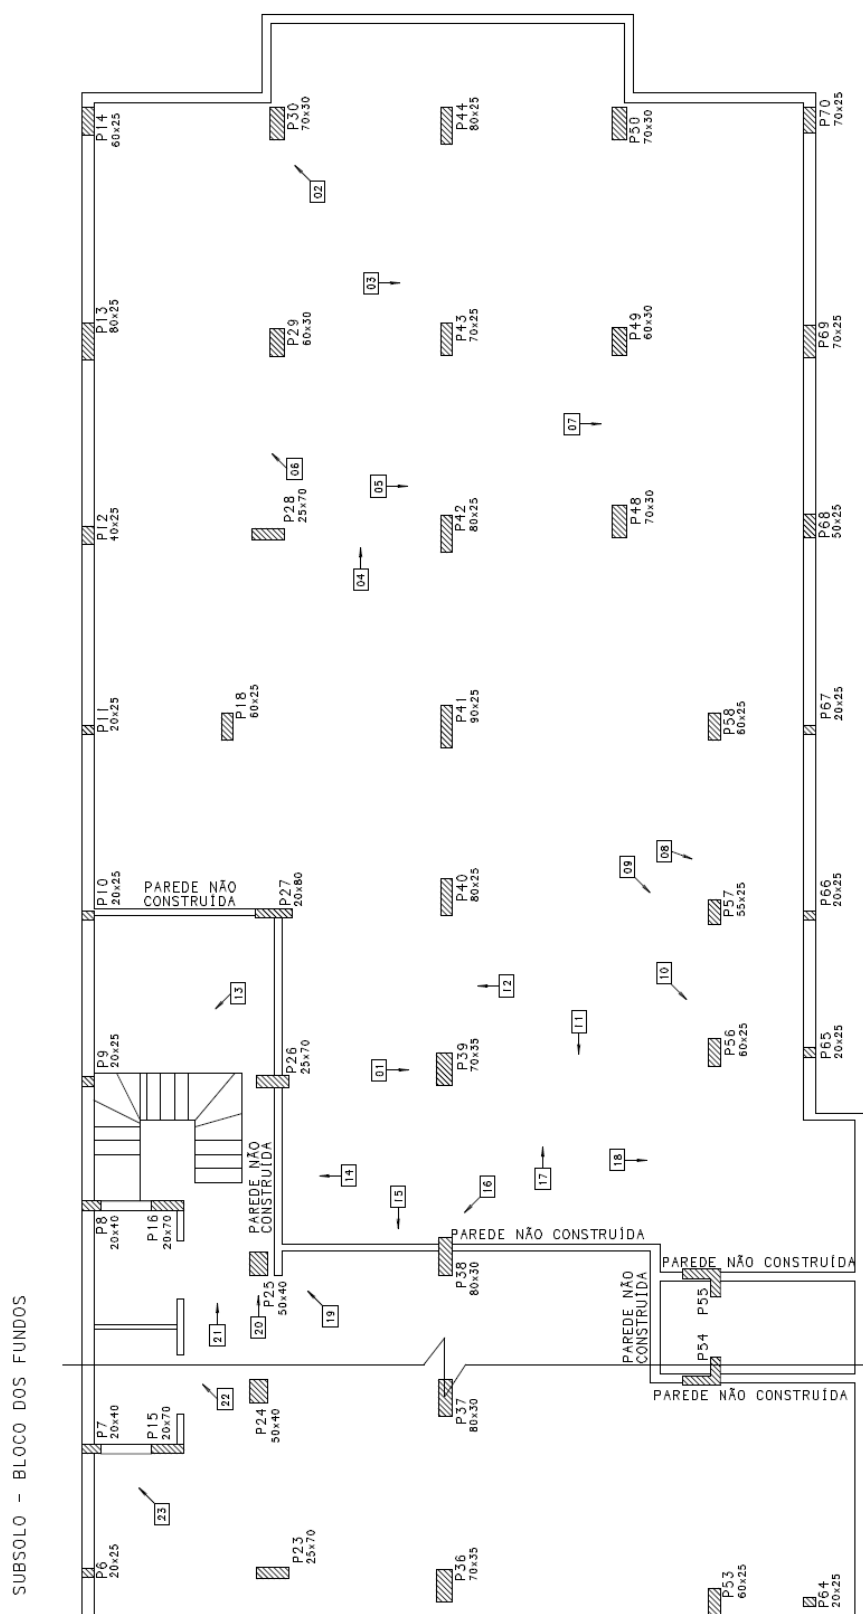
Planta baixa Bloco dos Fundos com locação das fotos
